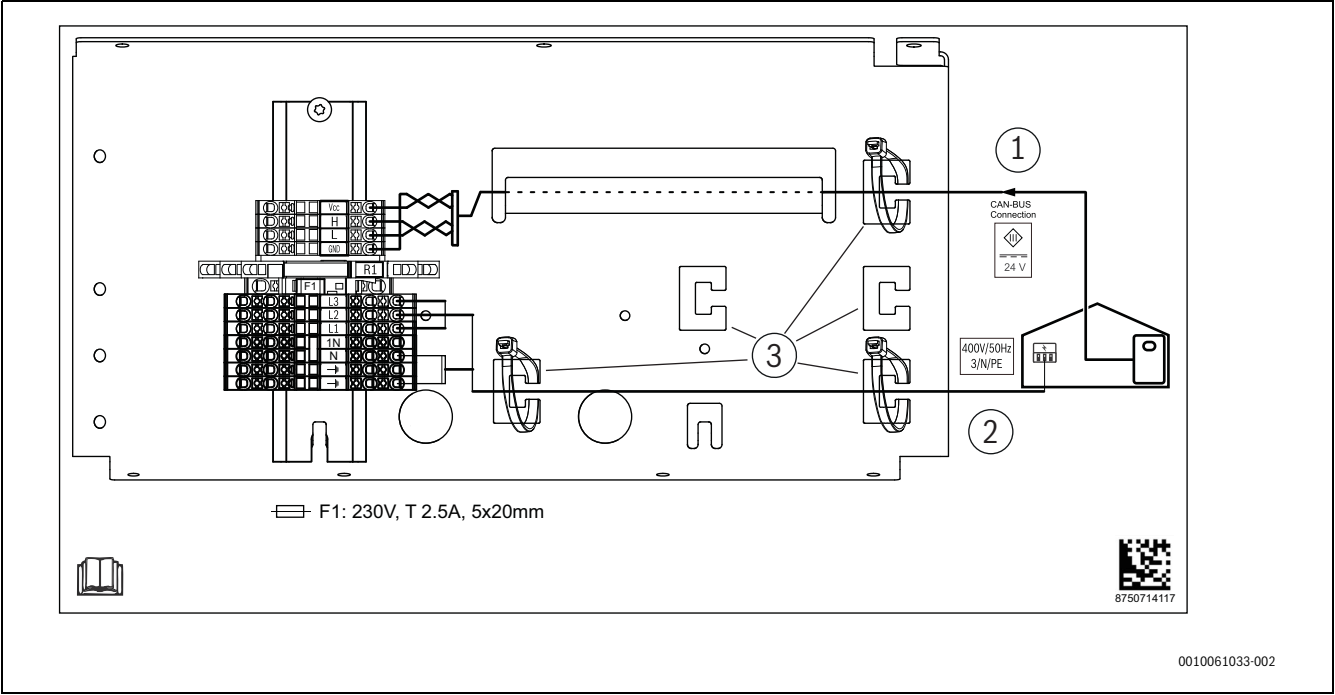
Anschlussklemmen im Anschlussbereich der Installation
